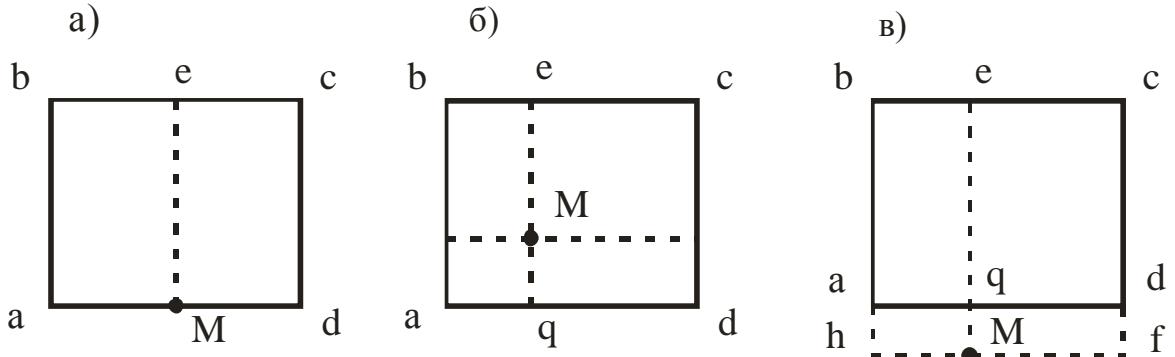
Схемы разбивки прямоугольной площади загрузки при определении напряжений по методу угловых точек
